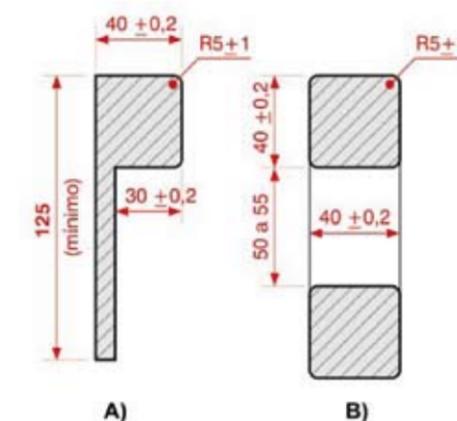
(A e B) - Seção transversal de corrimão da cabine. Dimensões em milímetros
